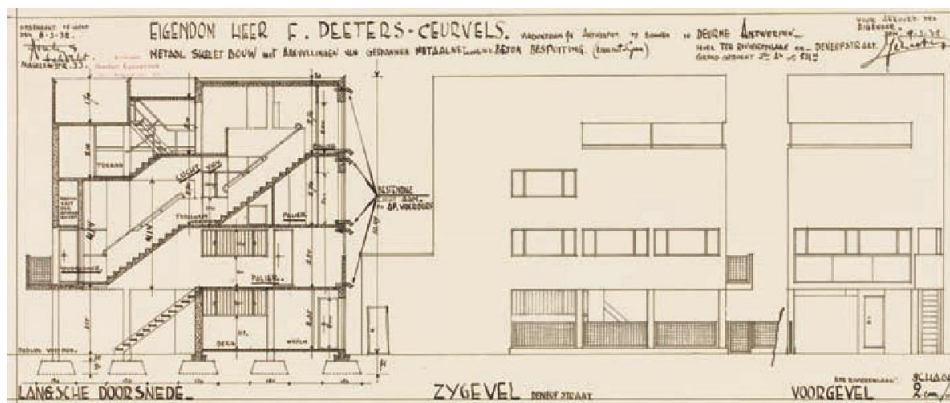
Planos de ejecución y sección longitudinal. Casa Peeters. Abril 1932.
